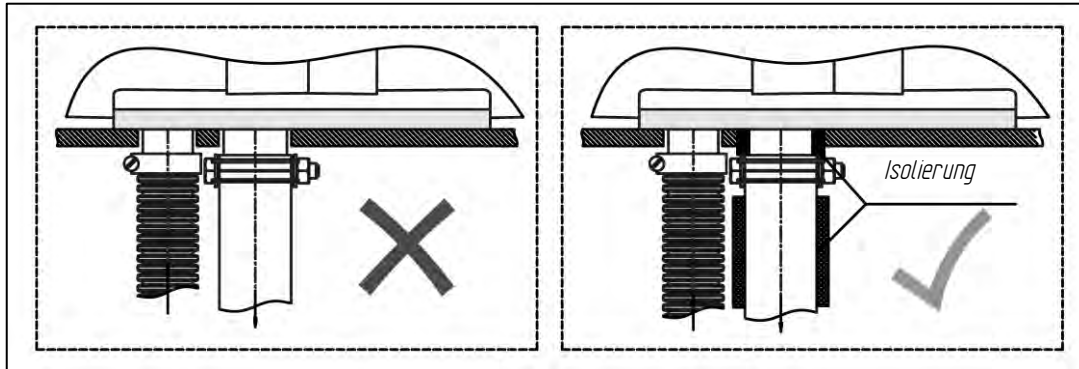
Einbau einer zusätzlichen Wärmedämmung
